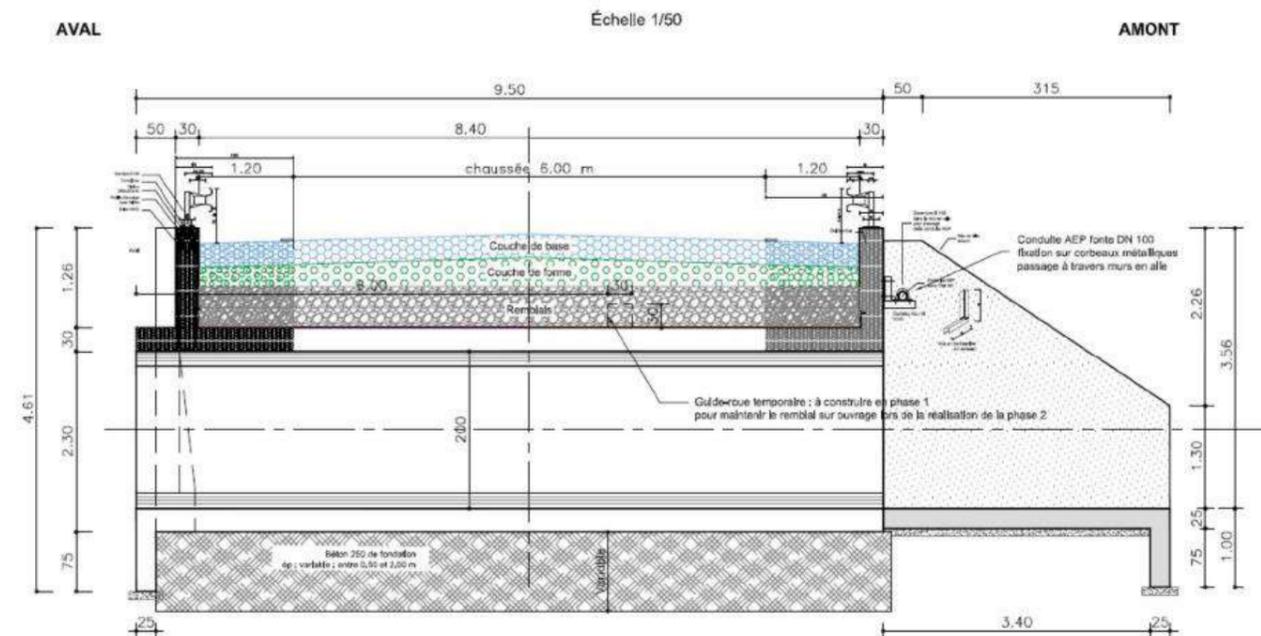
Coupe longitudinale (source : plan APD, ITCE, aout2023).
